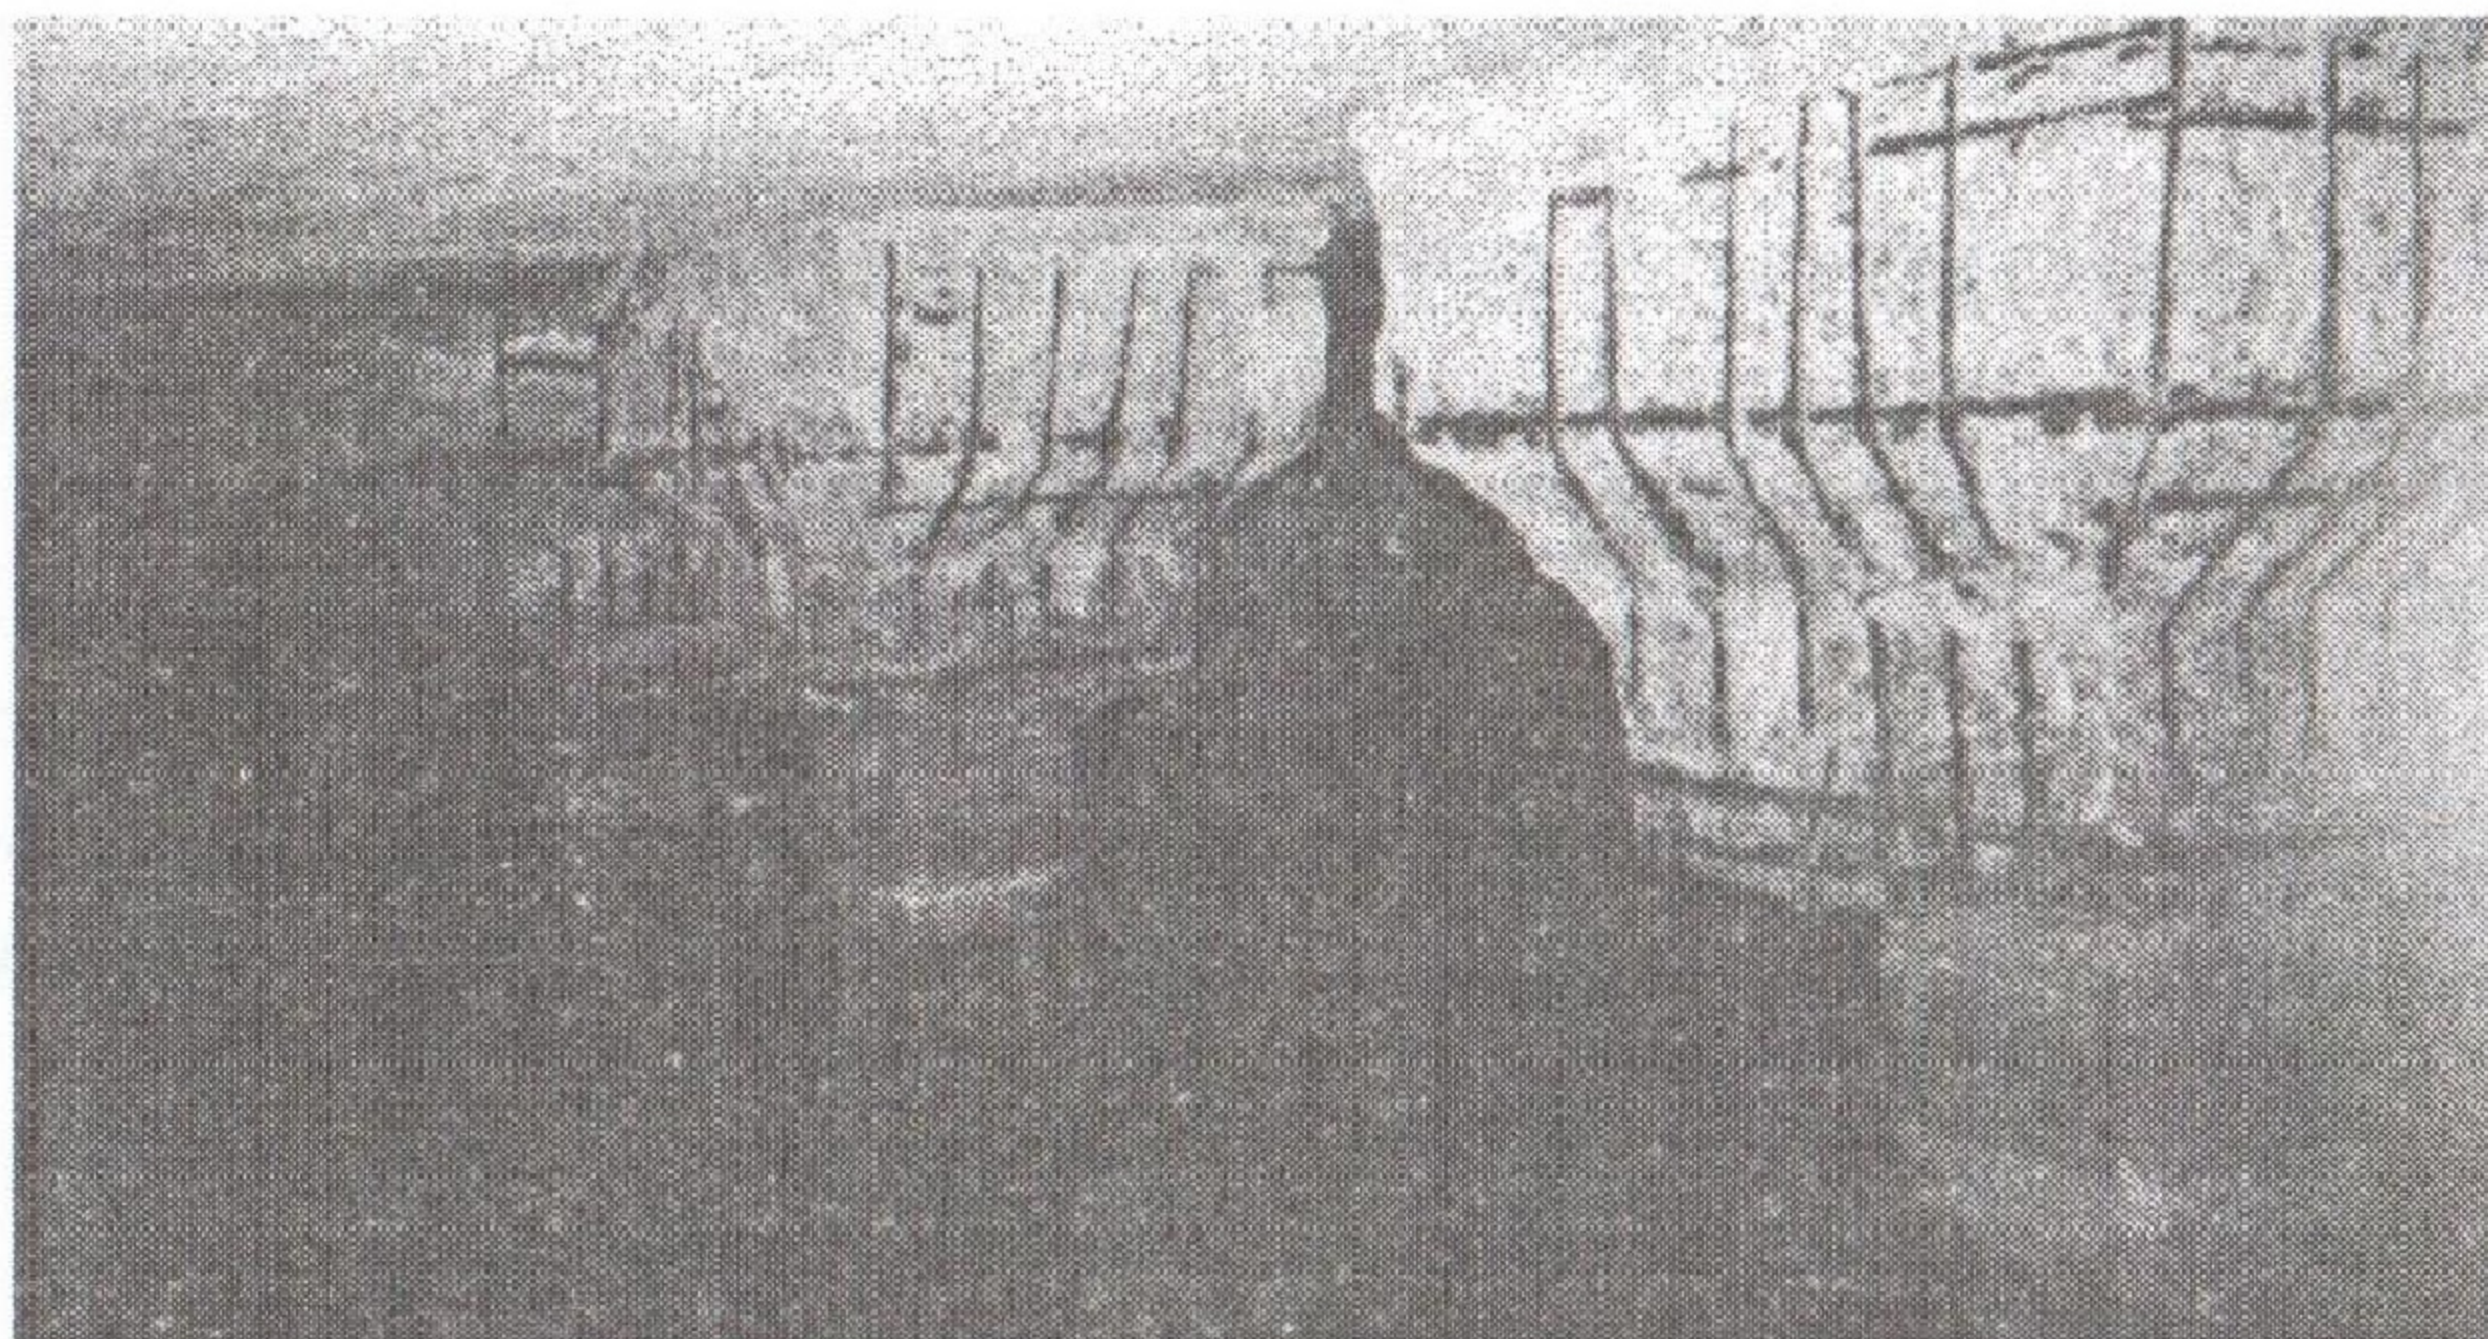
Конструкции железобетонных свай причалов до восстановления.
